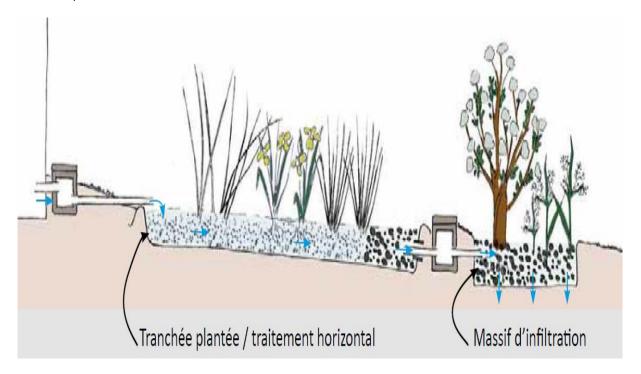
Coupe schématique d'une tranchée plantée (Source [6])
